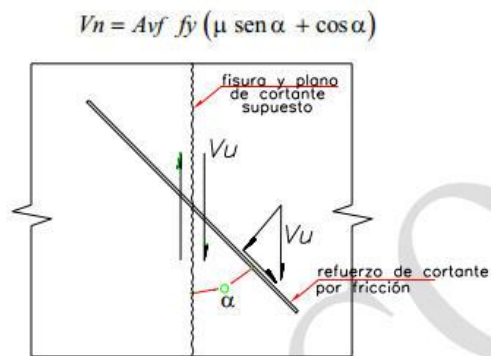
Refuerzo de corte por fricción inclinado con respecto a la fisura supuesta.
